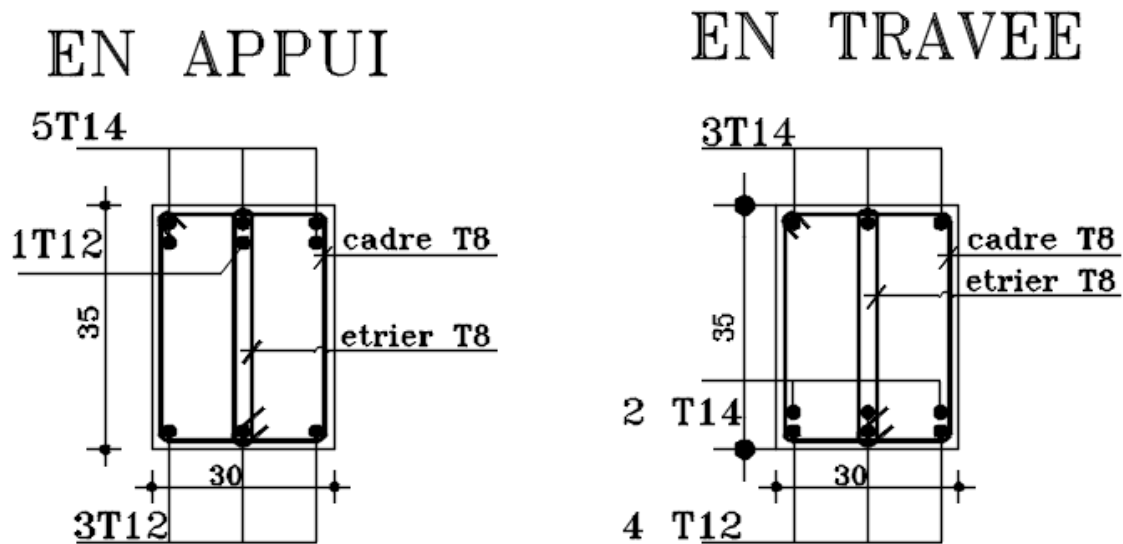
FERRAILLAGE DU POUTRE SECONDAIRE
